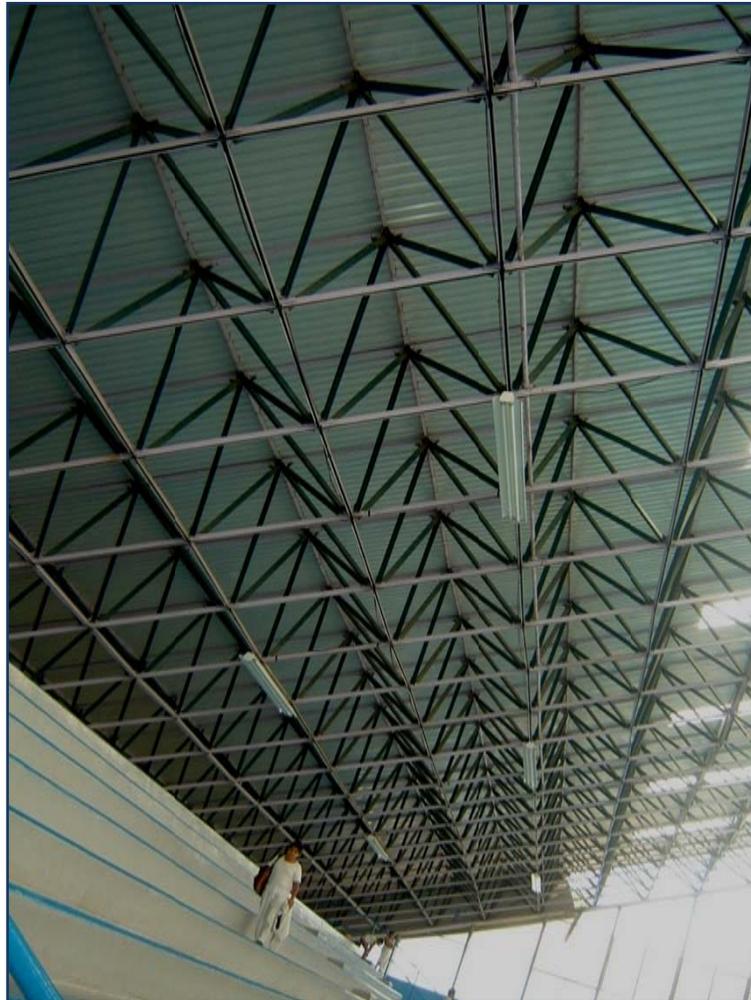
Techo de la alberca del Plan Sexenal.
